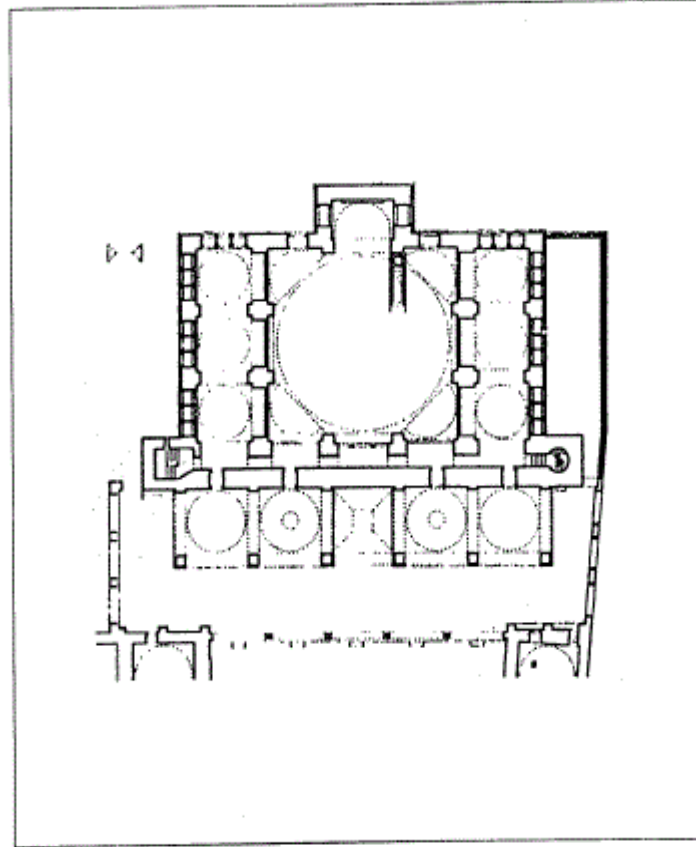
مسقط أفقي لمسجد مصطفى بك في شیراز (عن : كپل) .
